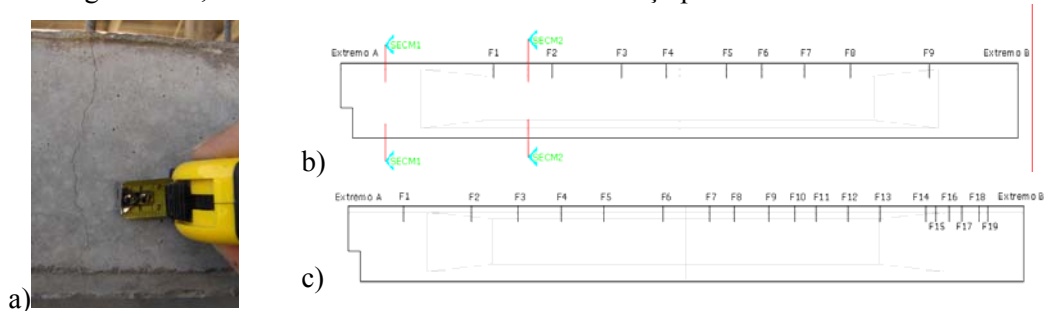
Fissuras observadas: a) e b) viga instrumentada; c) viga com cura térmica.
